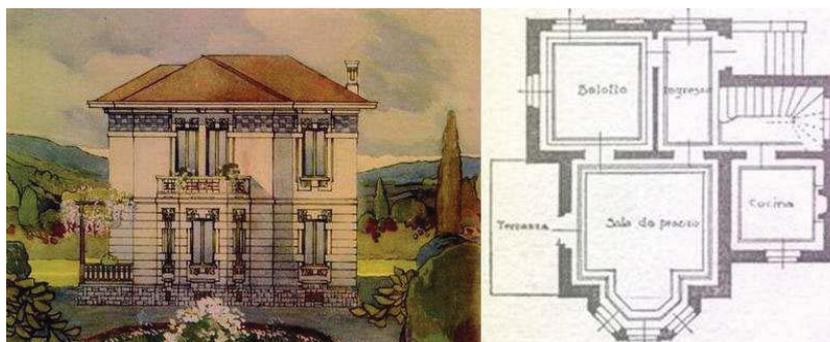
Desenhos originais do desenvolvimento das plantas baixas do projeto de Armando Boni para a residência na Rua Barão do Santo Ângelo 42.
